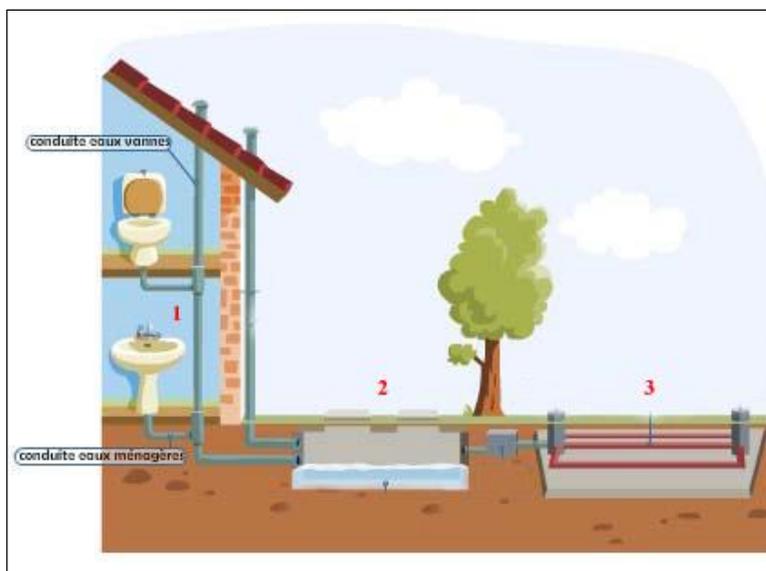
Schéma de l'installation d'un système d'assainissement non collectif [6]
